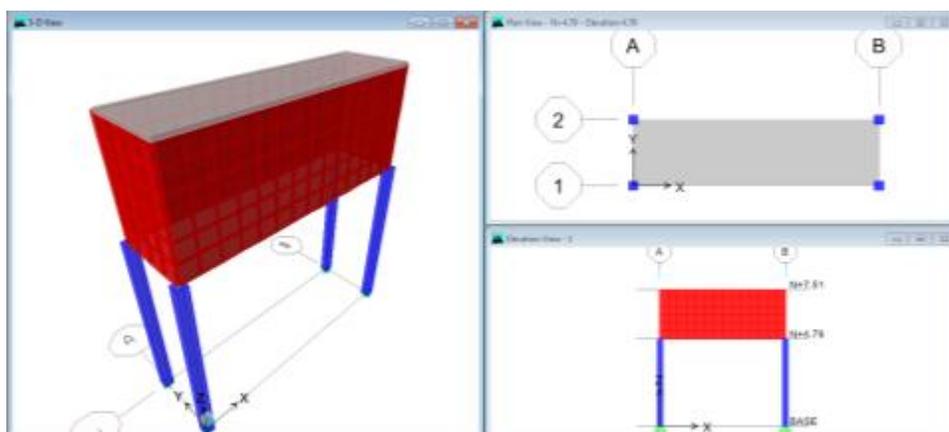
Modelo tridimensional (Estructura 9 Tanque Elevado)
